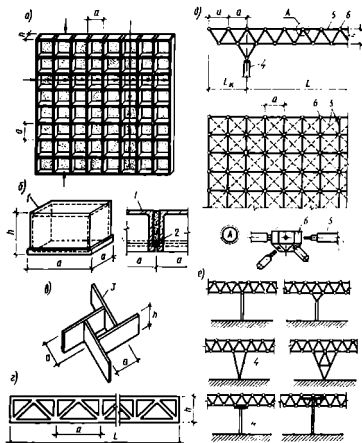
Перекрестно-ребристые и перекрестно-стержневые системы покрытий:
